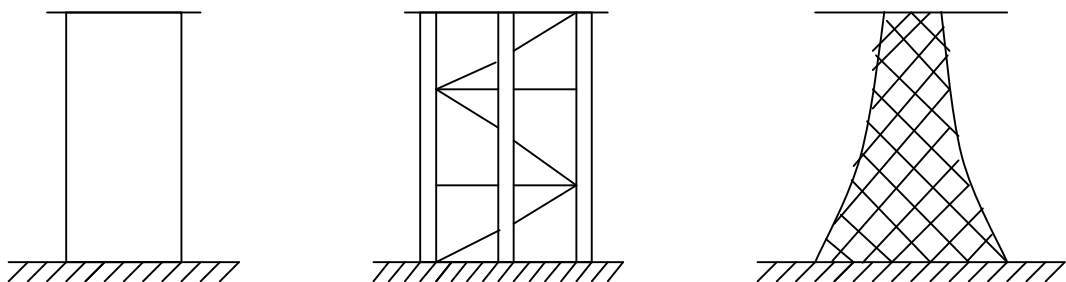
Схеми стовбурів водонапірних башт
